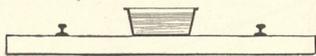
Gleisquerschnitt mit Wasserbehälter für selbsttätige Speisung.
